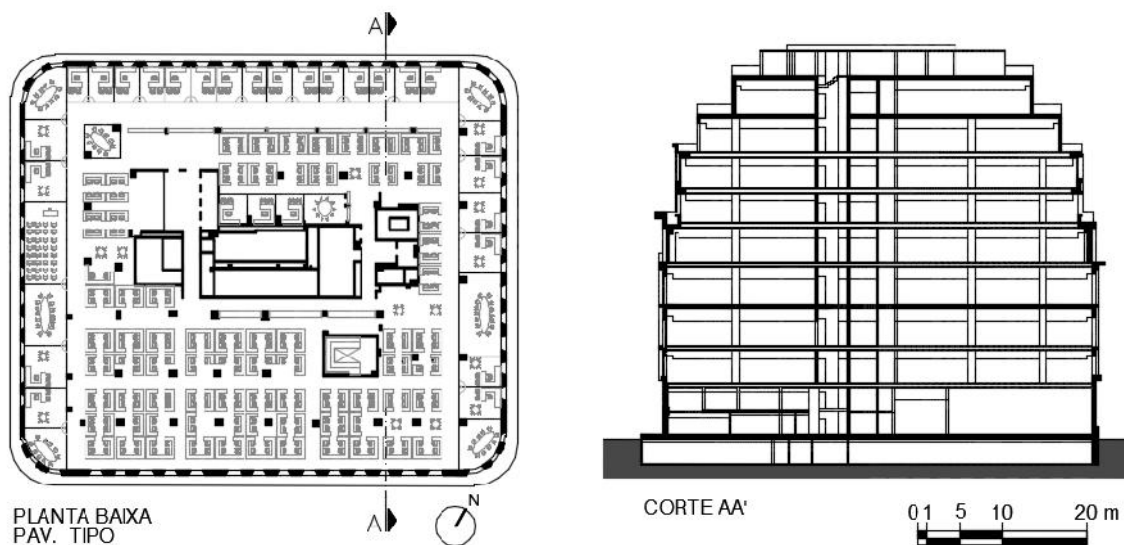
Ed. Galeria: planta do pavimento tipo e corte.
